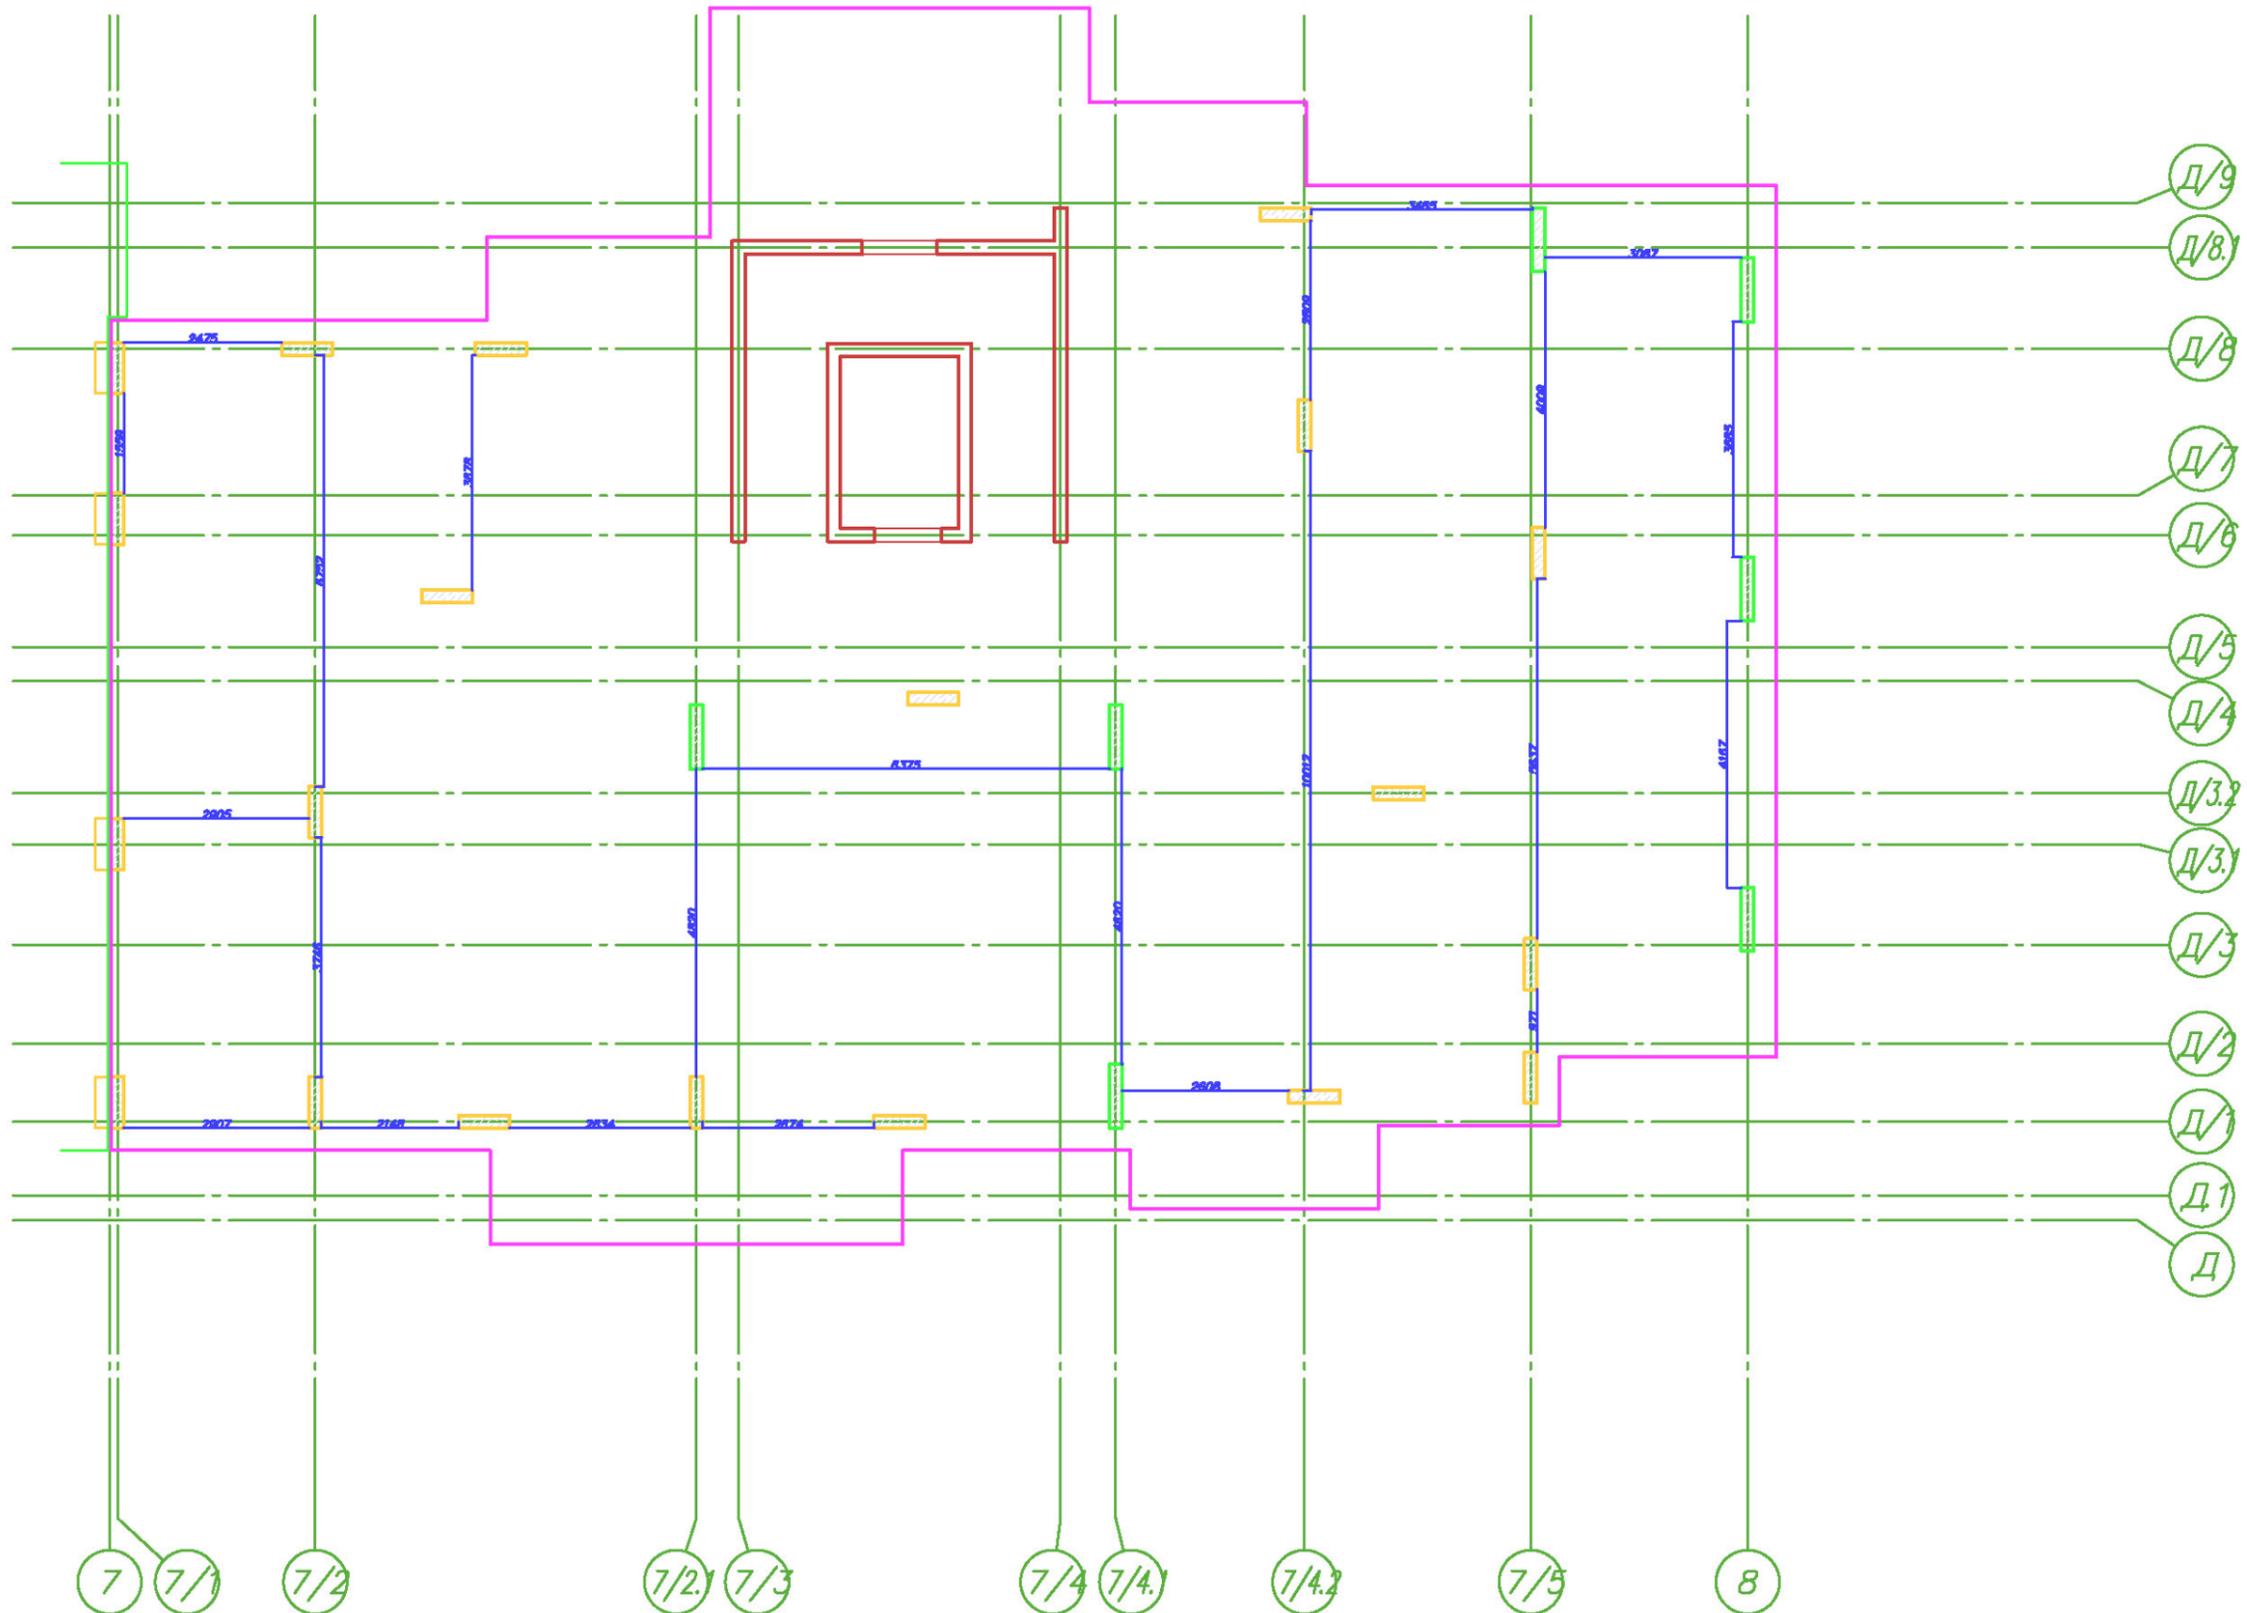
План фактически смонтированных конструкций 2-го этажа секции № 7
